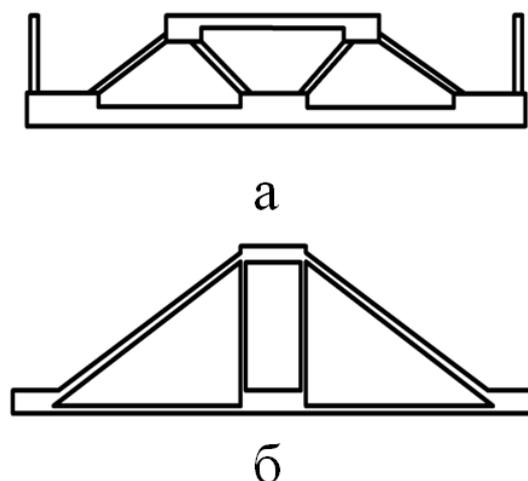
Железобетонные подстропильные фермы покрытий зданий со скатной (а) и малоуклонной (б) кровлей
